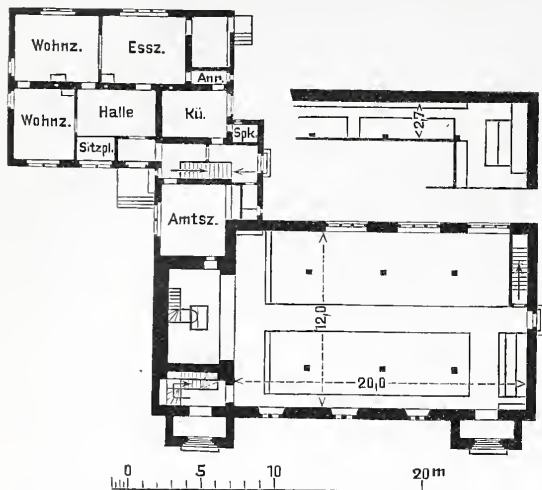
Grundriß zu ebener Erde und Teil vom Emporengrundriß der Kirche.
